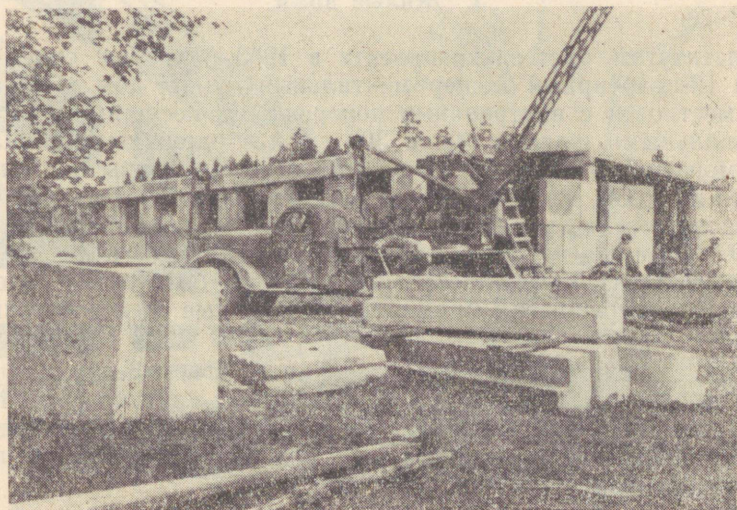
Монтаж каркаса животноводческих зданий автокраном.
